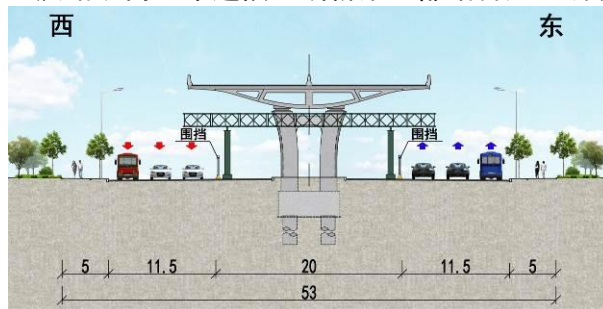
重庆路双向十车道段主线桥梁上部结构施工调流断面图
